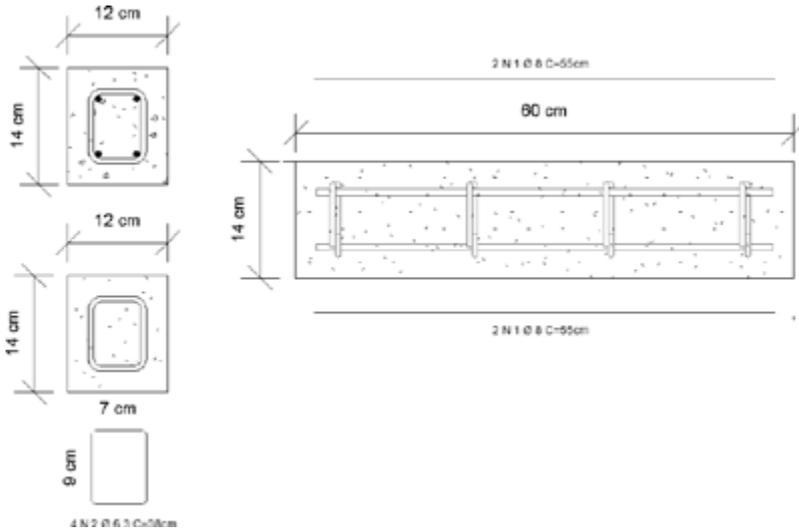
Detalhamento das Vigas de concreto armado com GFRP
